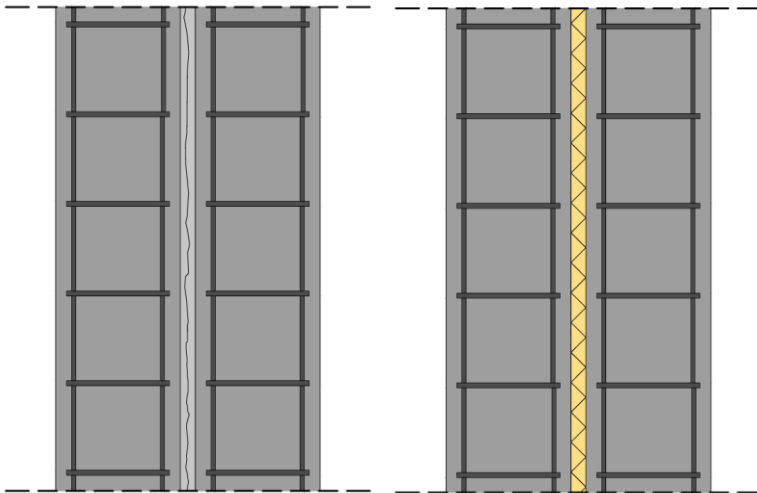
Detalle de reparación doble pilar. 2024. Fuente: Propia
